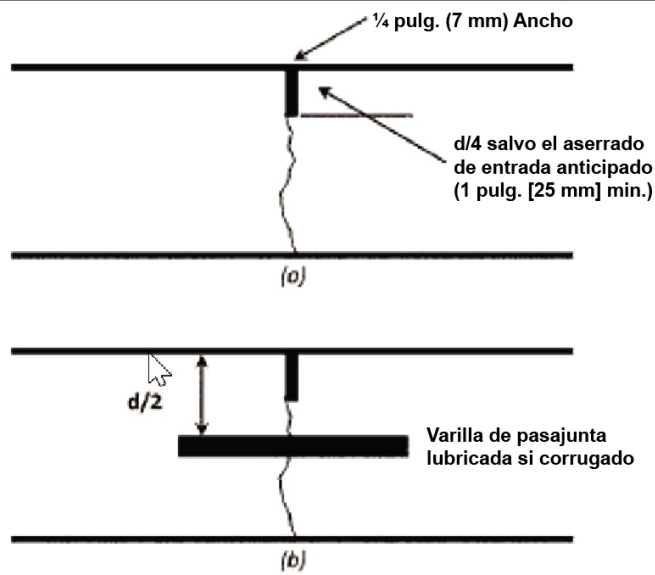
Tipos de juntas transversales de contracción (Fig 4.2 en ACI 325.12R-02(13))
